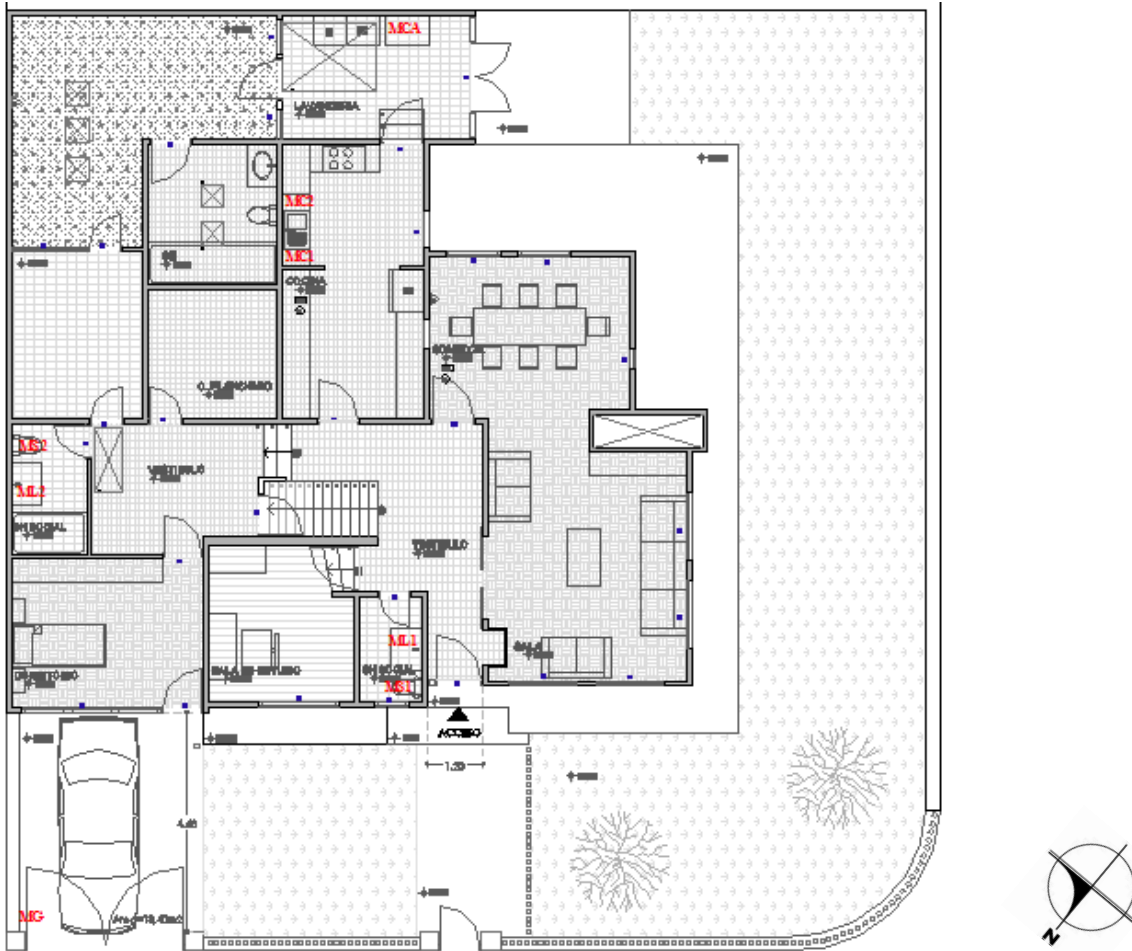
Planta primer nivel lugares en donde se instaló medidores
